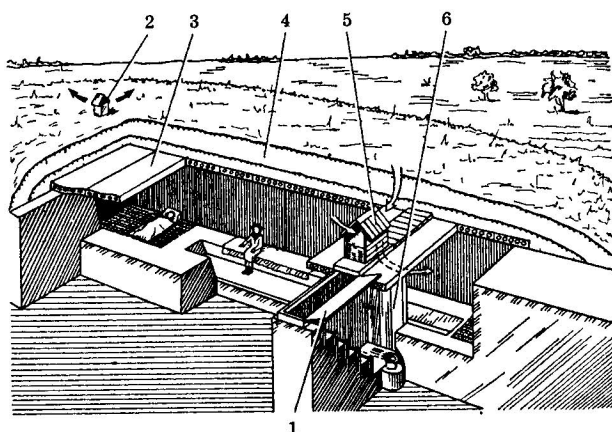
Протирадіаційне укриття з перекриттям із залізобетонних плит:
